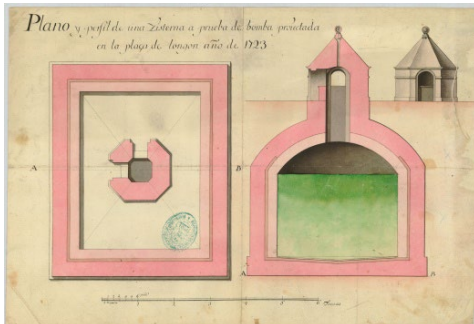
Plano y perfil de una cisterna en Longón, 1723, España, Ministerio de Defensa, Archivo General Militar de Madrid (AGMM), C-8-14
